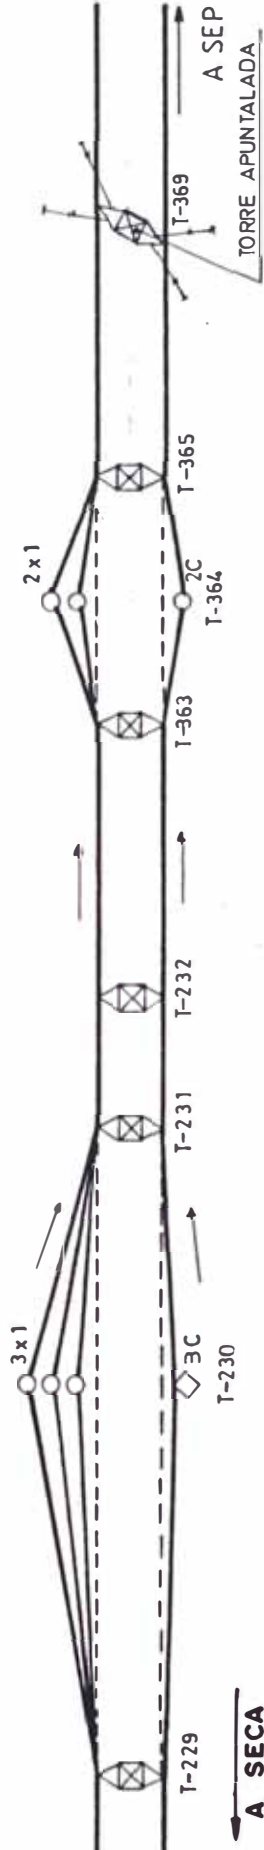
PLANIMETRIA DE 2 TERNAS DE UNA LINEA RECUPERADAS PROVISIONALMENTE.
